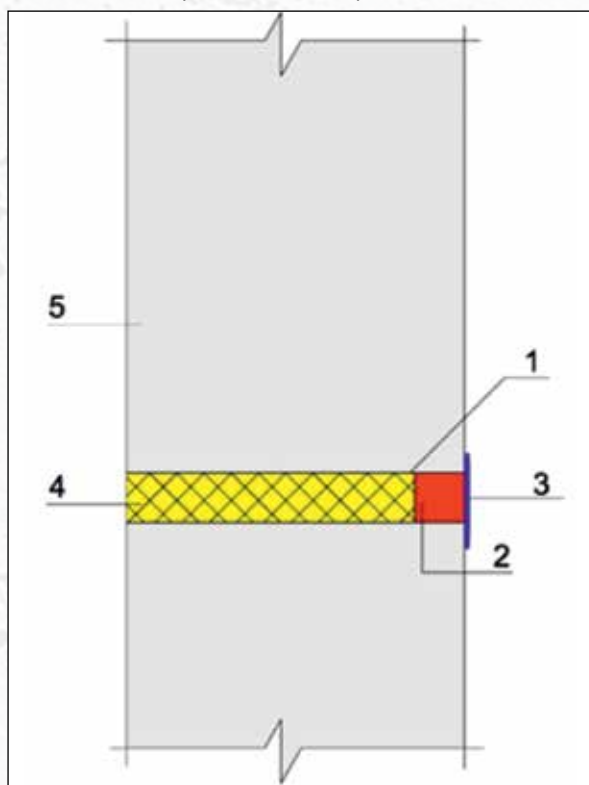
Гидроизоляция технологических отверстий от стяжек опалубки:
